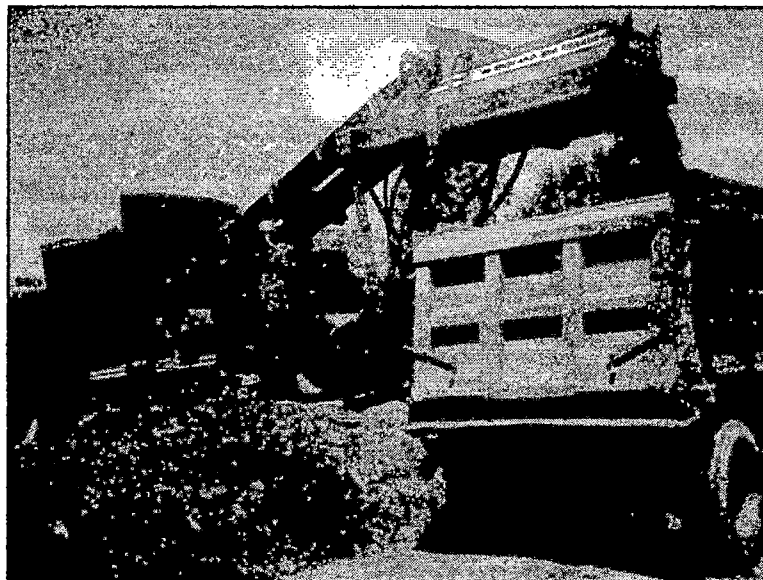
Planta portátil de mezcla asfáltica en frío.
